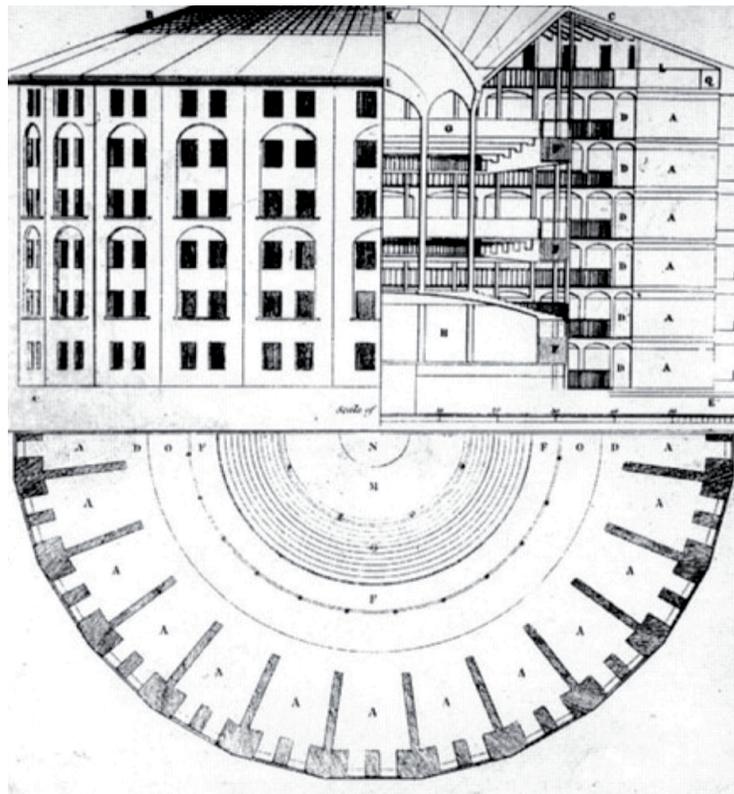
Planta y alzado del Panóptico de Jeremy Bentham
